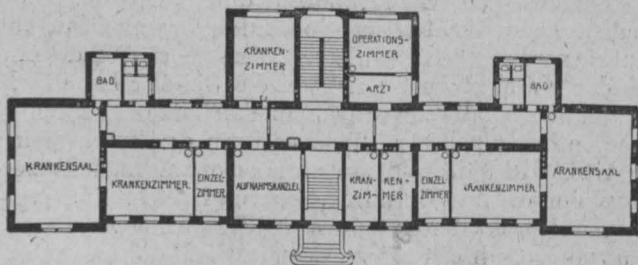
Hauptgebäude, Erdgeschoß; Allg. öffentl. Krankenhaus in Eggenburg
